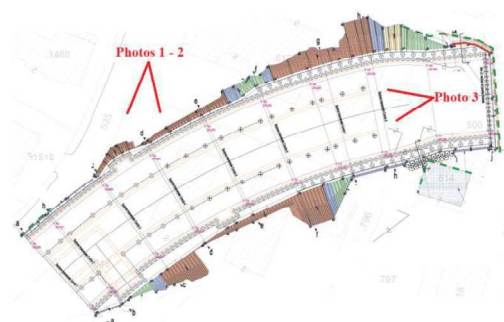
Pianta scavi con identificazione dei punti di vista delle foto 1, 2 e 3
